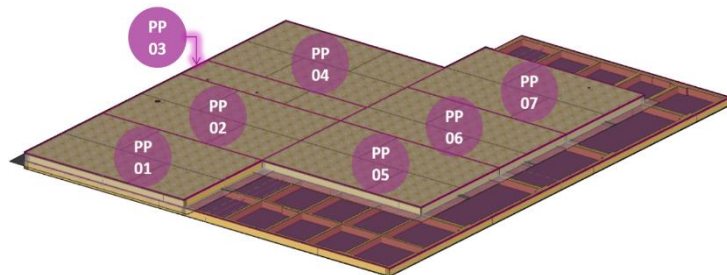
Paneles de piso. Adaptado de modelo Cadwork Proyecto 23BP-246692 (2024).
